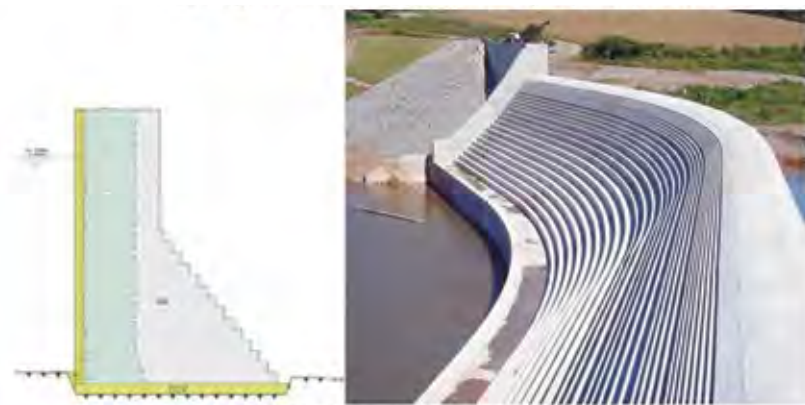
Barragem de concreto compactado a rolo (CCR)
